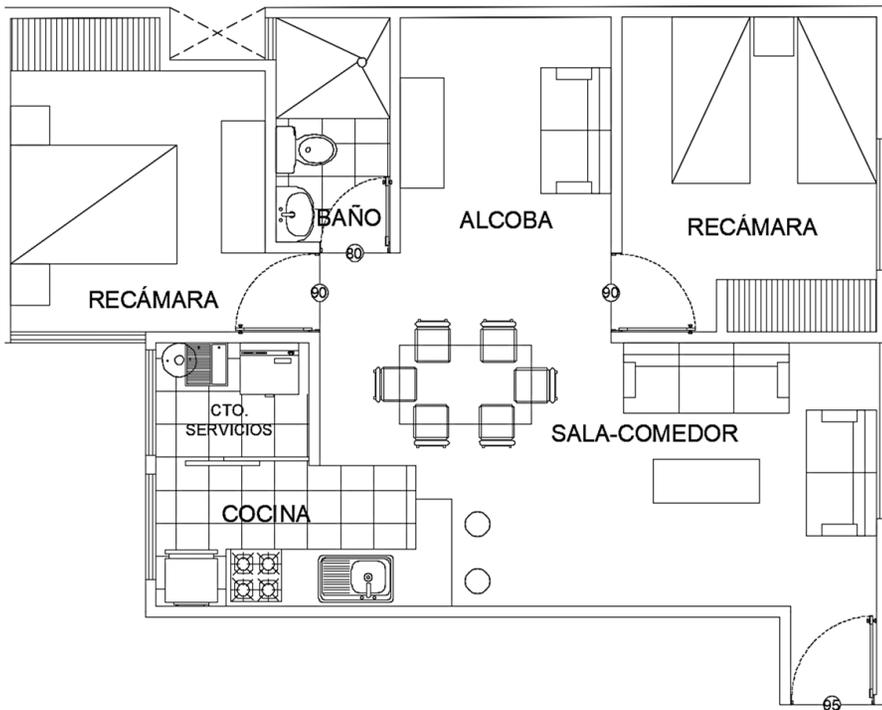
Pantitlán Planta tipo. 64.63 m²
